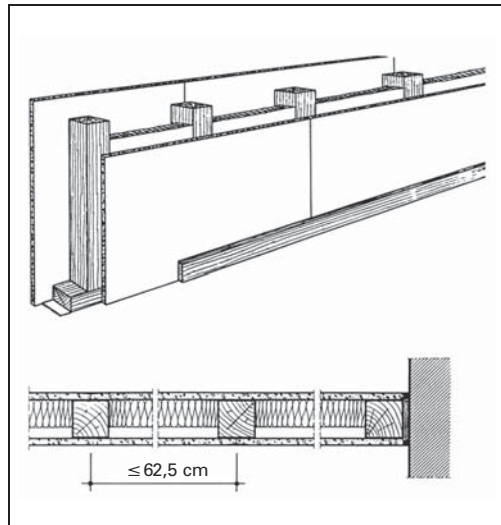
Holzeinfachständerwand, einfach beplankt
